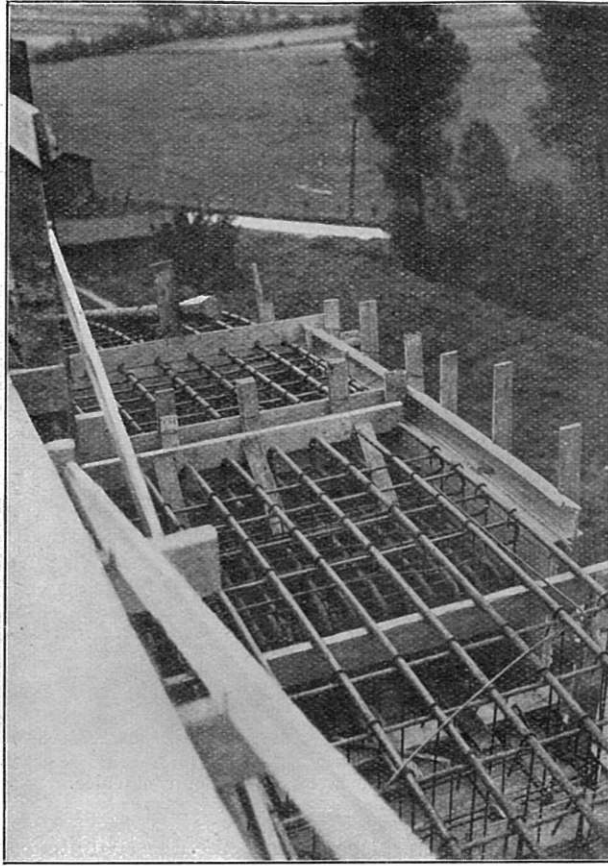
Viaduc de la Pède. — Ferrailage d'une articulation de clef.
